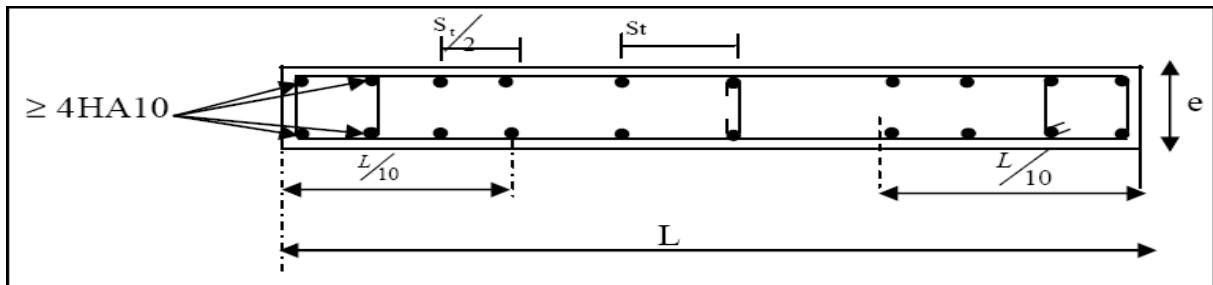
Disposition des armatures verticales dans les voiles.
